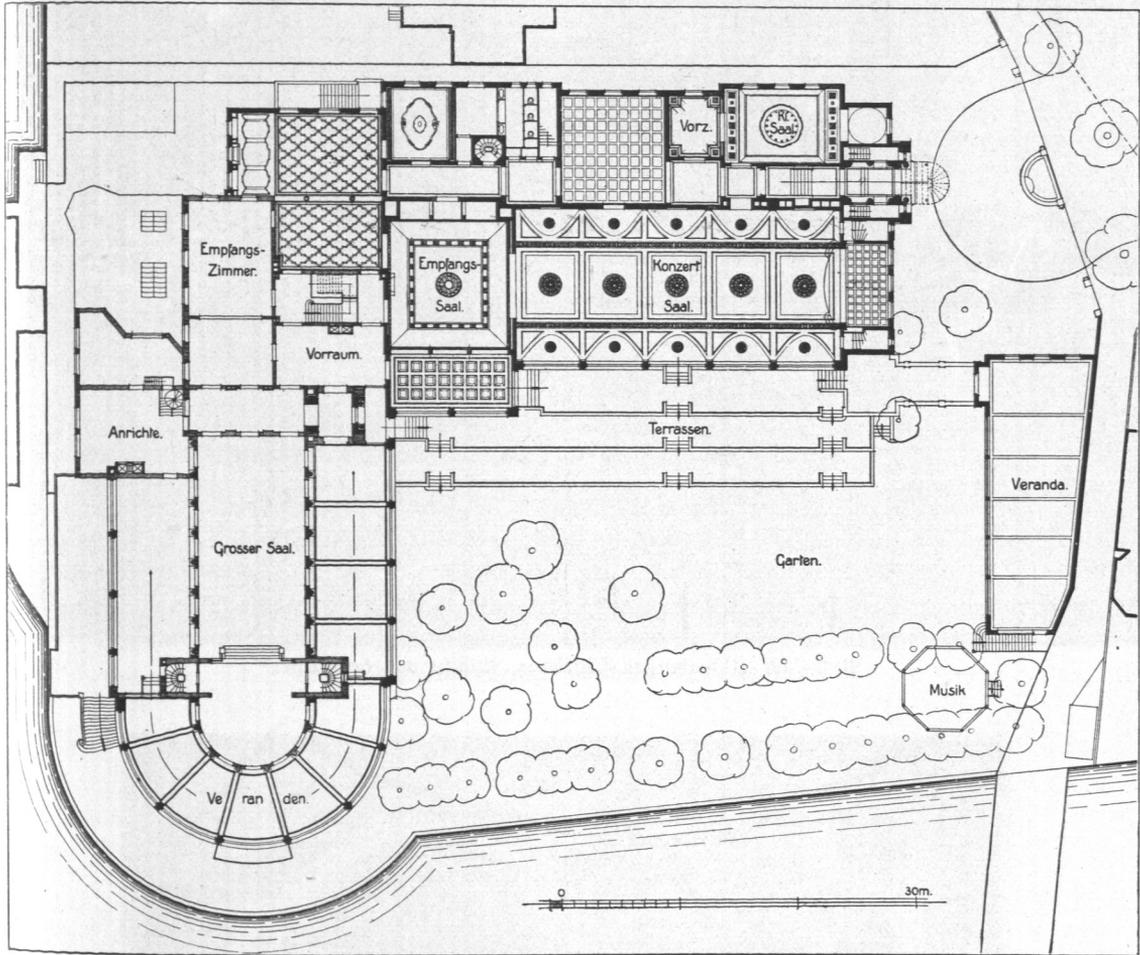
Uhlenhorster Fährhaus, Grundriß.
